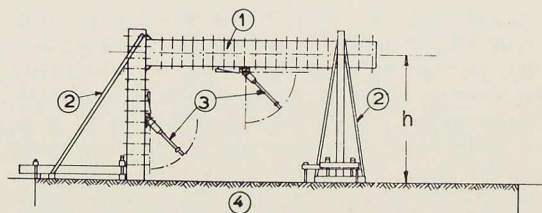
Equerres et poutre de l'installation G. I. M. E. D.
